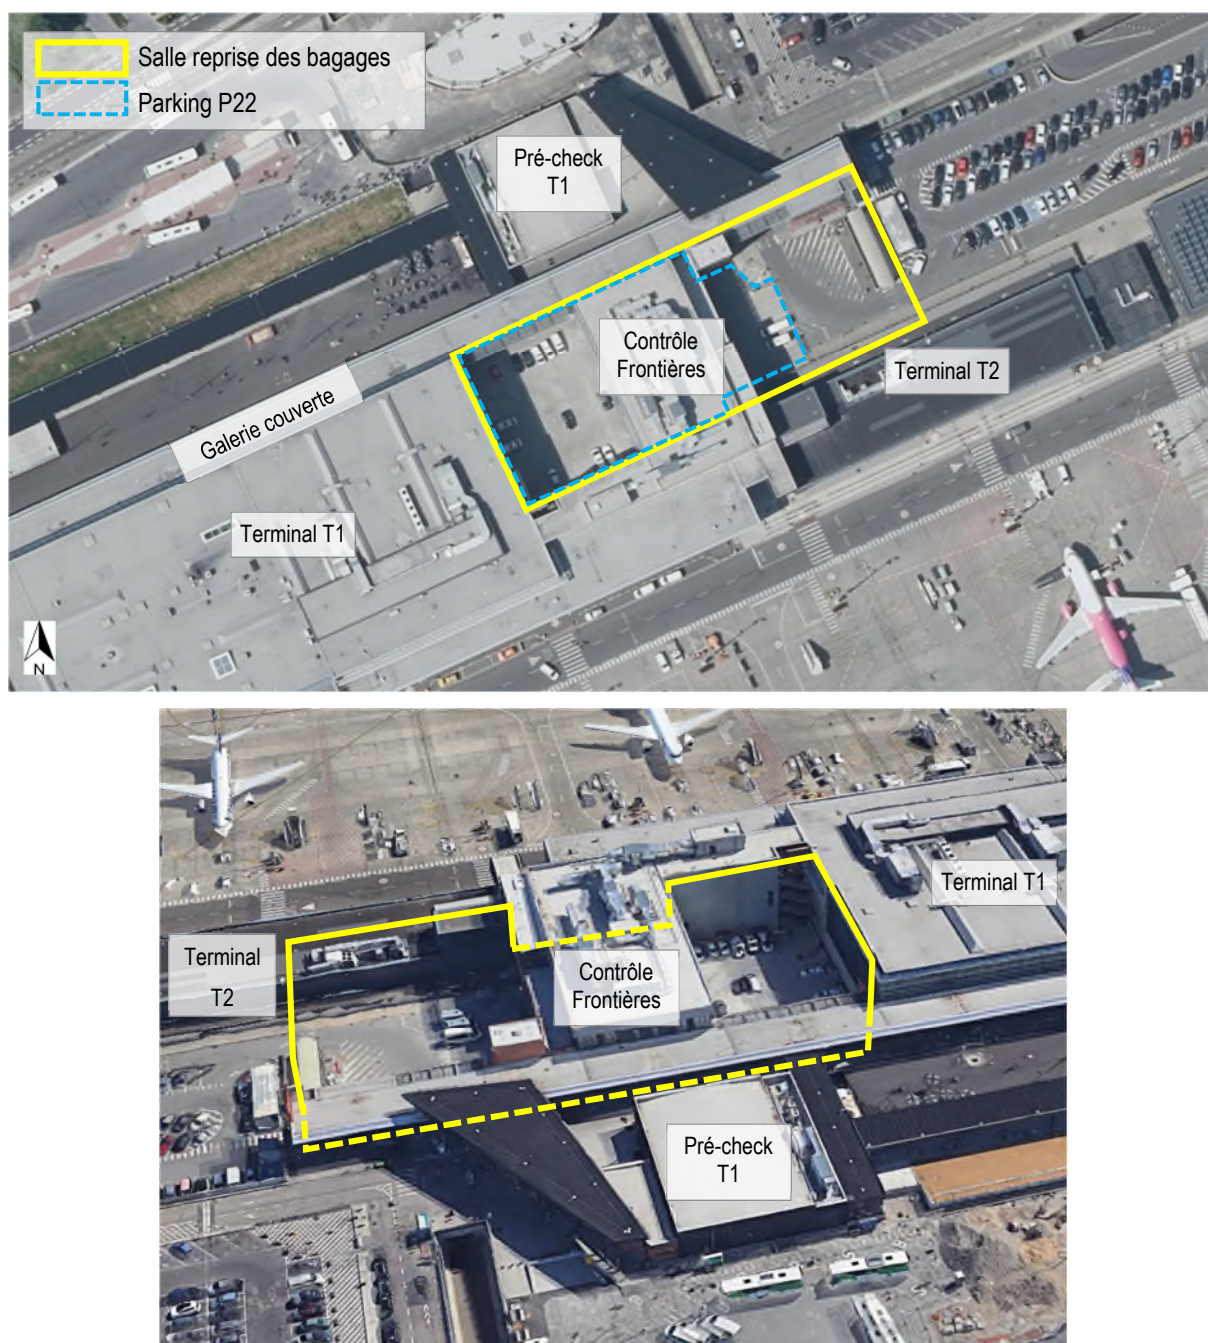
Localisation envisagée pour la future salle de reprise des bagages (ARIES sur fond WalOnMap et Google Earth, 2024)
